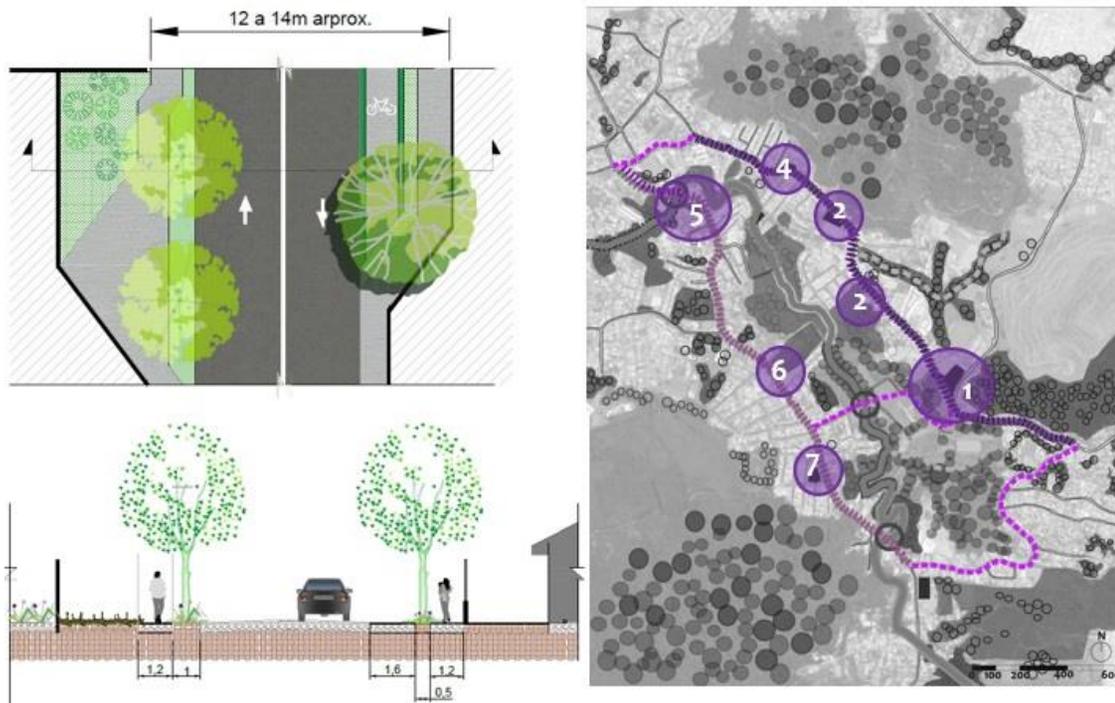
Planta arquitectónica tipo, corte transversal y conjunto de calles con propiedades con potencial a ceder espacio. Fuente: Elaboración propia.
